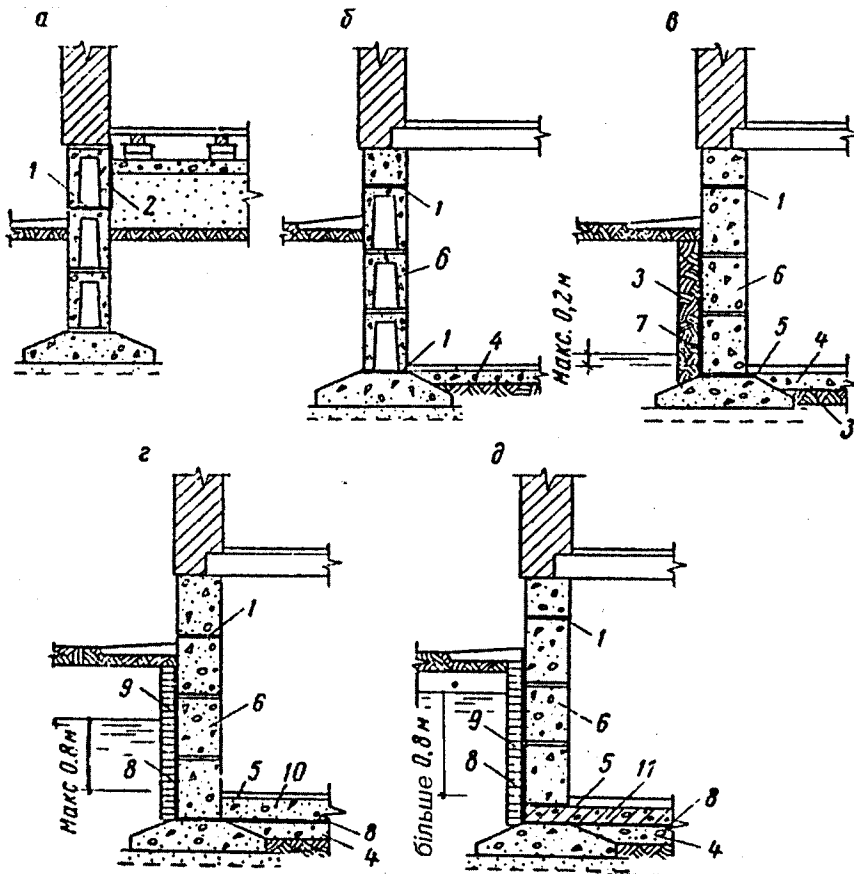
Ізоляція будинку від ґрунтової вологи: а,б – гідроізоляція за відсутності напору підґрунтових вод; в,г,д – те ж, при напорі підґрунтових вод (а – будинок без підвалу; на інших рисунках будинки з підвалом); 1 – горизонтальна гідроізоляція; 2 – вертикальна гідроізоляція; 3 – м'ята масна глина; 4 – бетонний підмурок; 5 – чиста підлога; 6 – стіна підвалу; 7 – обмазка гарячим бітумом; 8 – гідроізоляційний килим; 9 – захисна стінка; 10 – бетон; 11 – залізобетонна плита.
